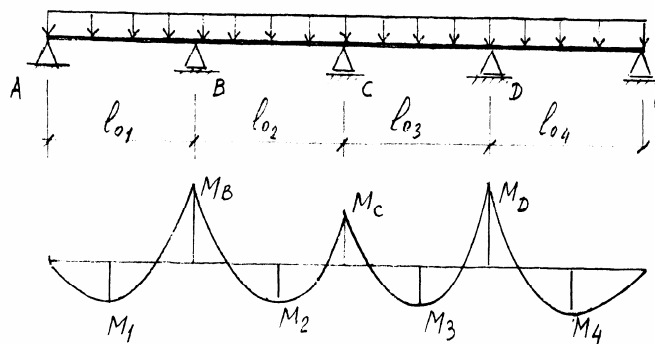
Розрахункова схема балкової плити і епюра згинальних моментів
